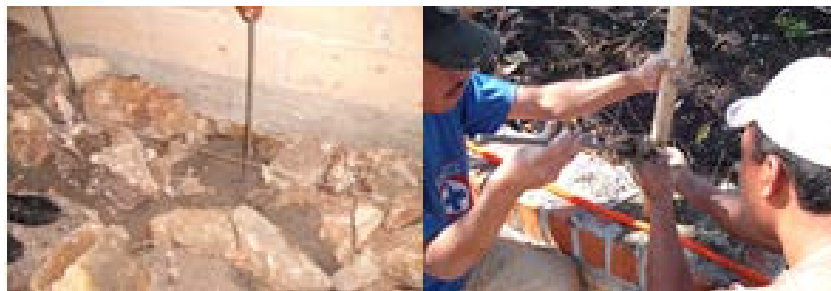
Detalle de anclaje de varilla a la cimentación e "inyección" de mortero cemento-arena al bambú ahogando la varilla dentro del mismo
